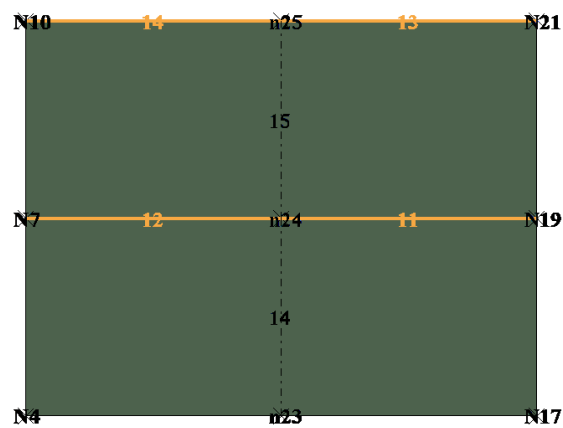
Prospetto Parete 6 - Modello Scollegato
